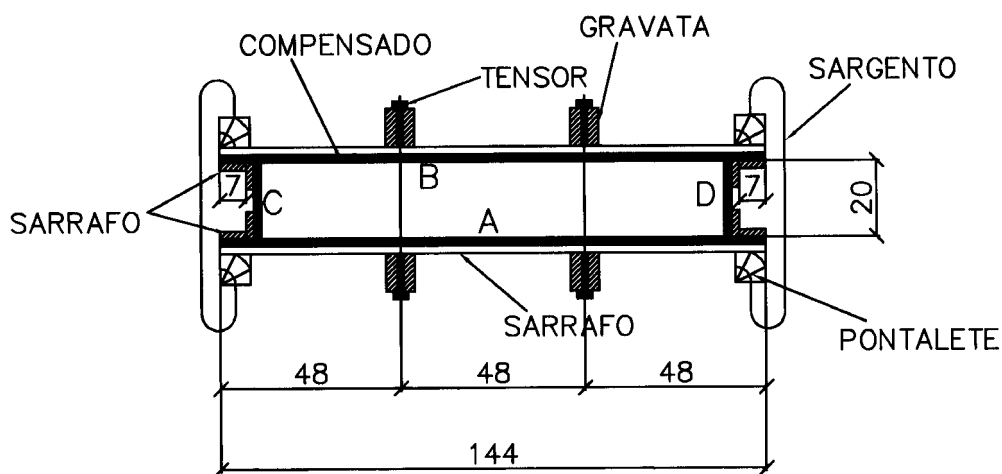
Detalhe da planta dos painéis de pilar (medidas em cm).
